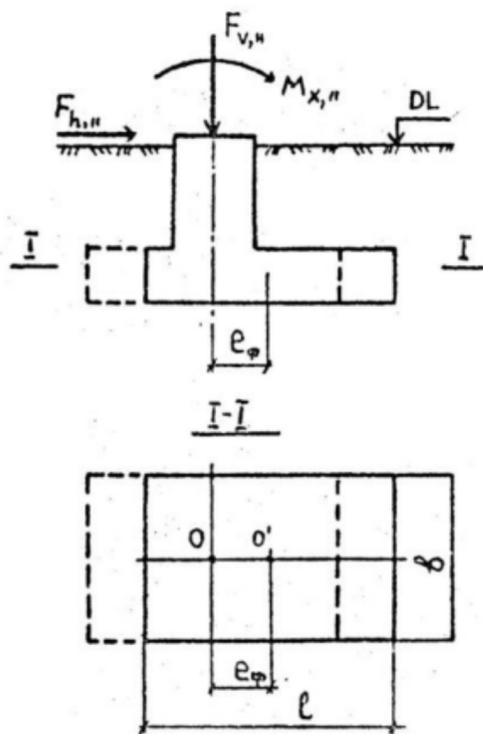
Схема размещения подошвы фундамента относительно оси колонны при центральном нагружении (штриховая линия); при действии значительных по величине моментов (сплошная линия): 0 – точка пересечения оси колонны с подошвой фундамента; 0' – геометрический центр подошвы фундамента
